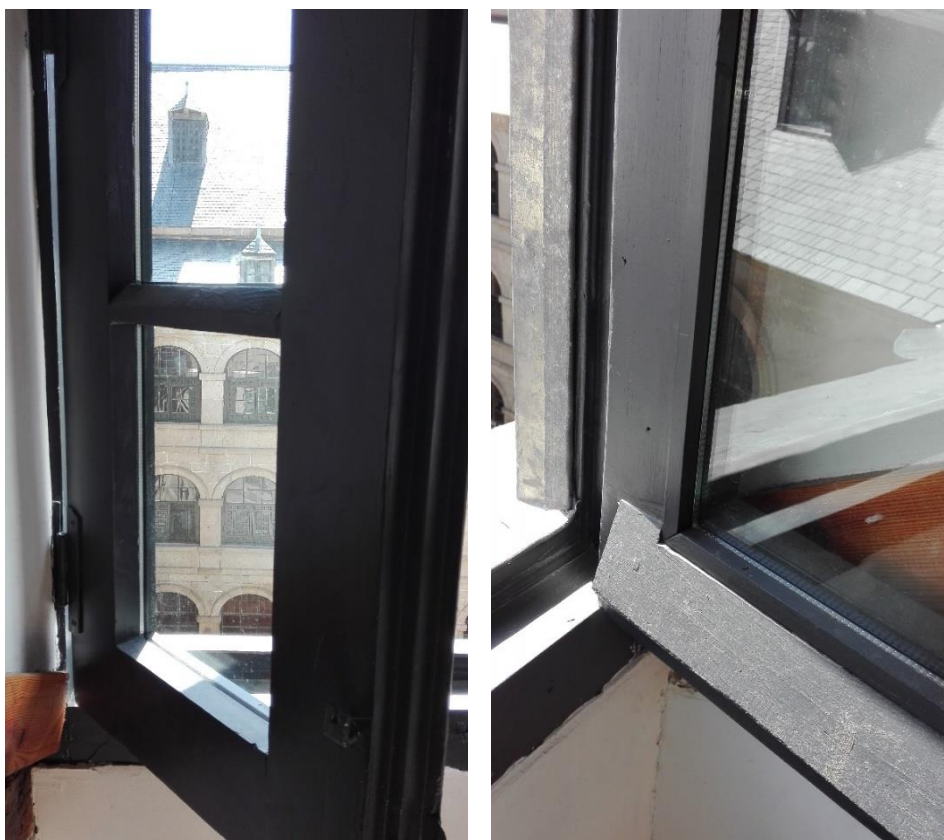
Detalles de las carpinterías modificadas ya con el nuevo acristalamiento. Fuente: Elaboración Propia
